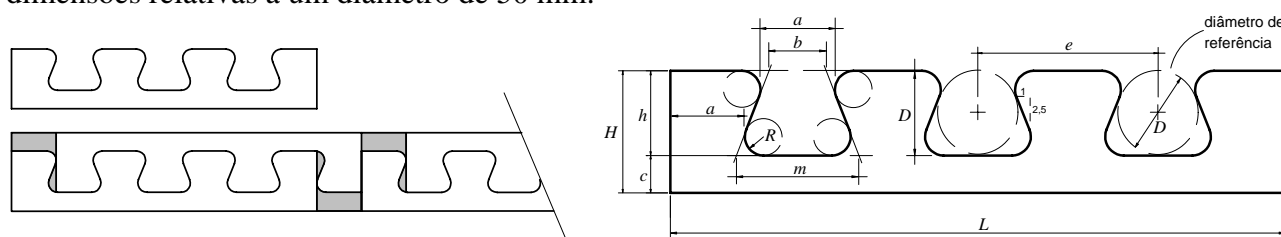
O conector Crestbond aplicado com pré-laje de concreto pré-fabricada.
